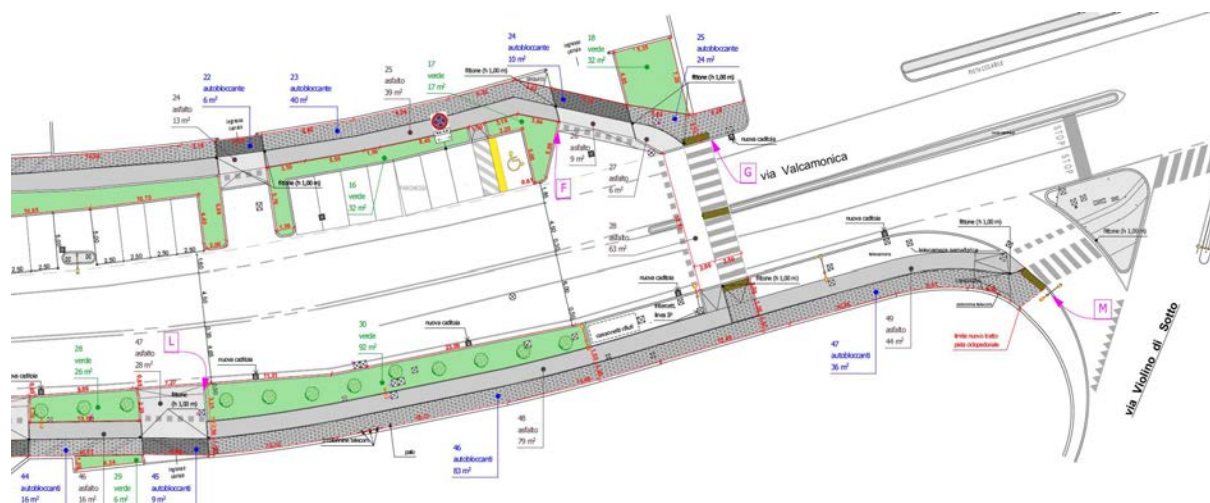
Estratto Tav. 6.8 - Verde e Illuminazione (Quadro III)
